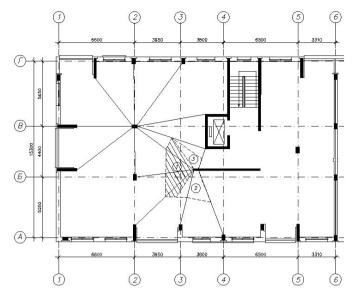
Фрагмент плана 3-го этажа административно-хозяйственного здания
